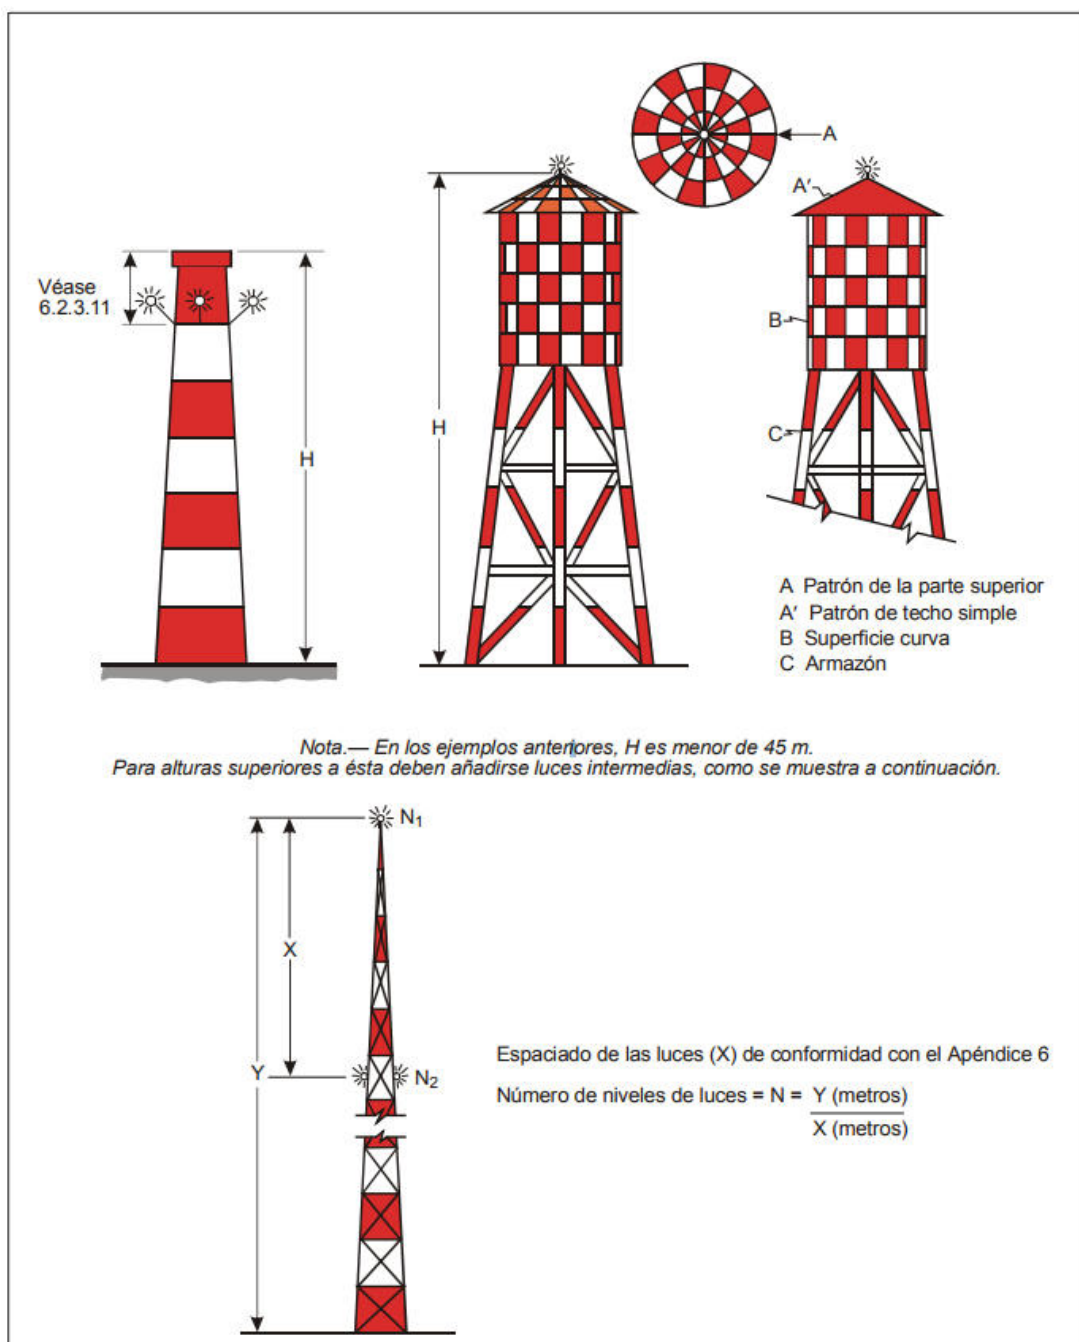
Ejemplos de señalamiento e iluminación de estructuras elevadas
